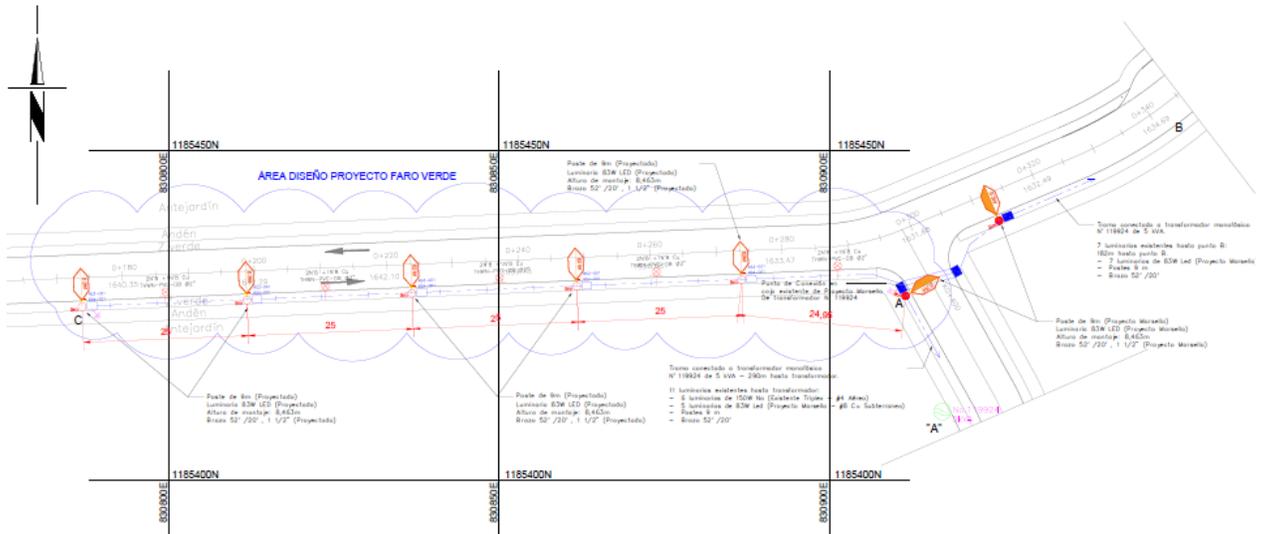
Proyecto en ejecución: SS 156881 Faro Verde.
